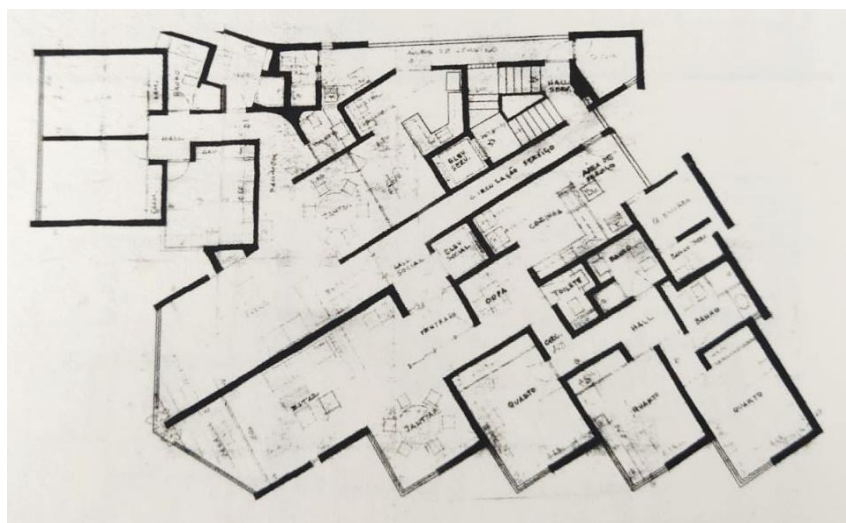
Planta baixa tipo do edifício Mirage, 1967. Fonte: Naslavsky (2012, p. 153).
